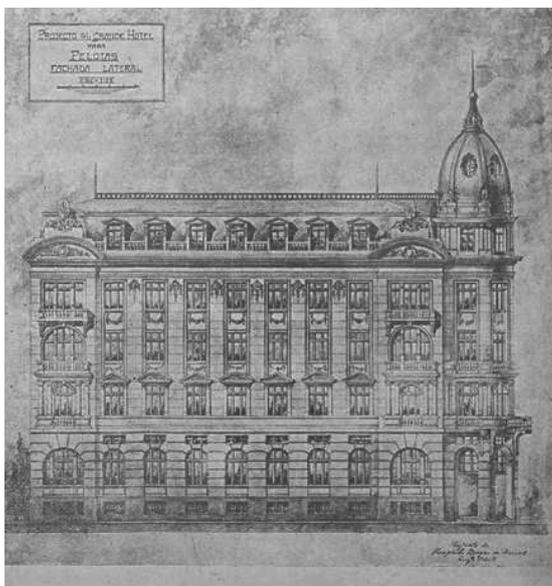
Fachada voltada para a rua Anchieta, desenho de autoria de Barros.
